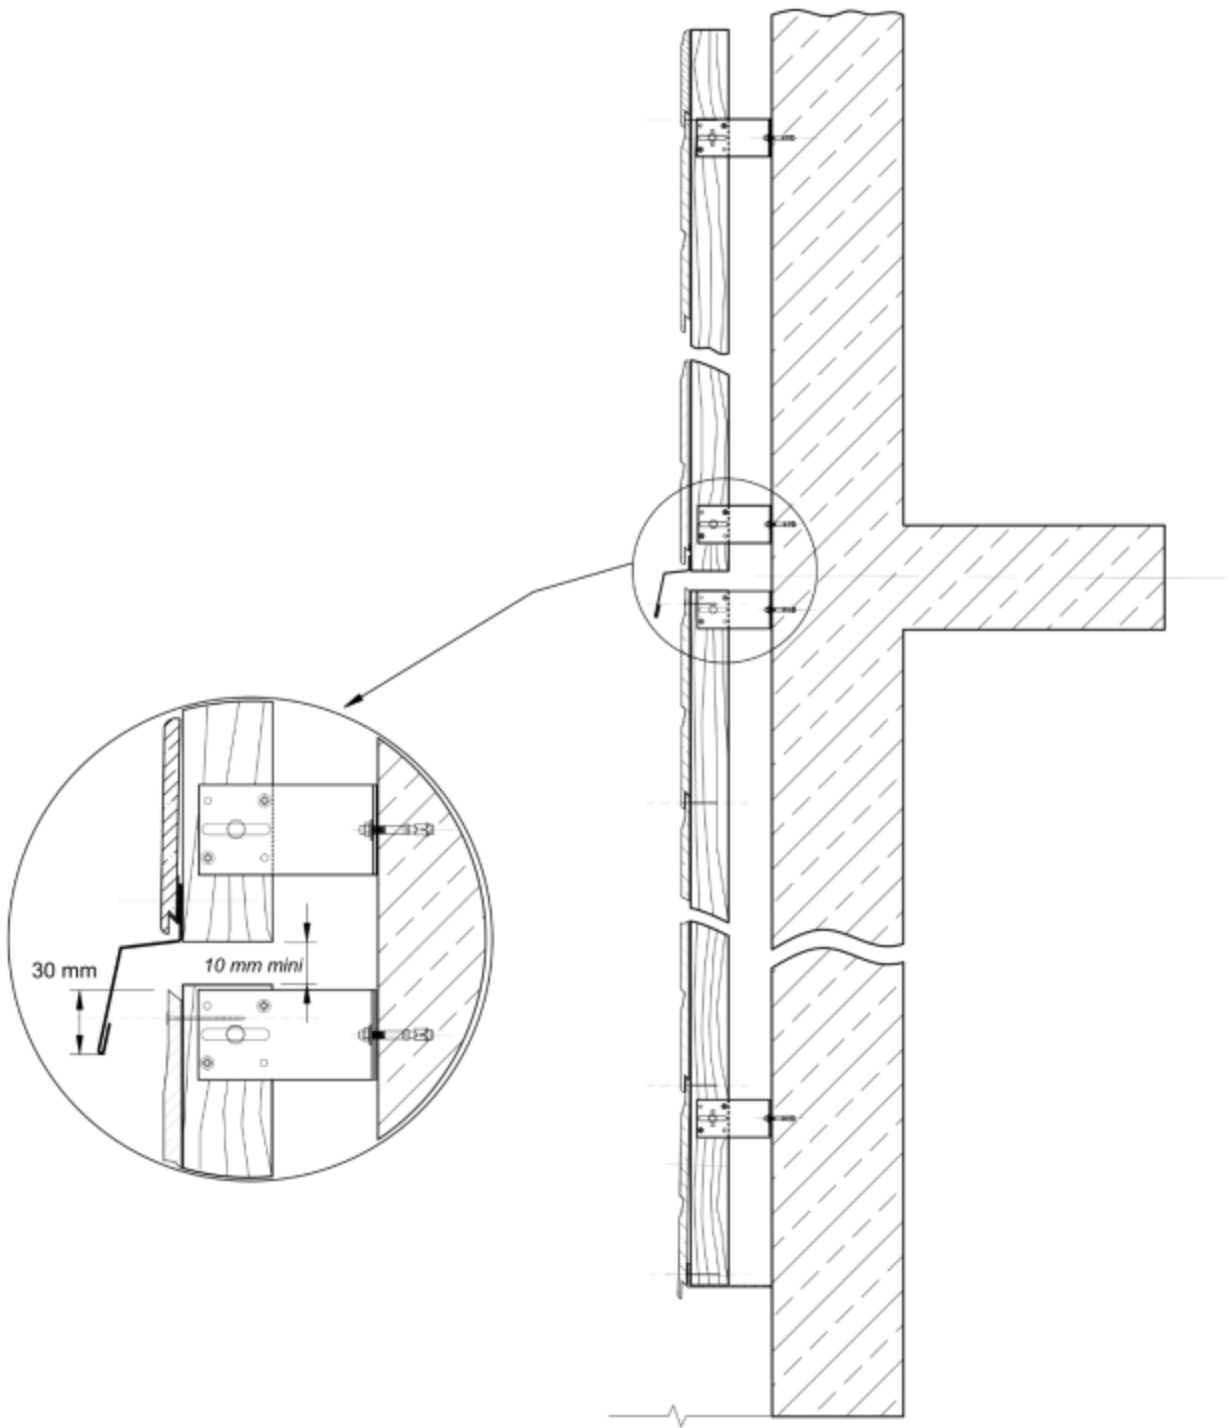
Fractionnement de l'ossature au droit de chaque plancher sur béton
